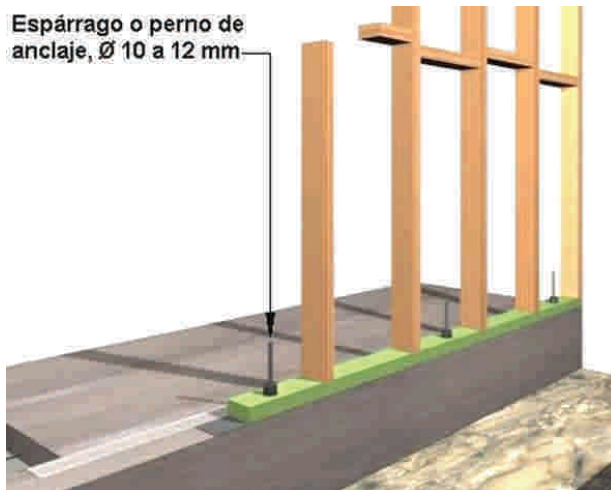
36: Detalle constructivo de la distribución de espárragos o barras de anclaje. Espaciamiento de 120 mm entre el último perno y el extremo del término del tabique.
